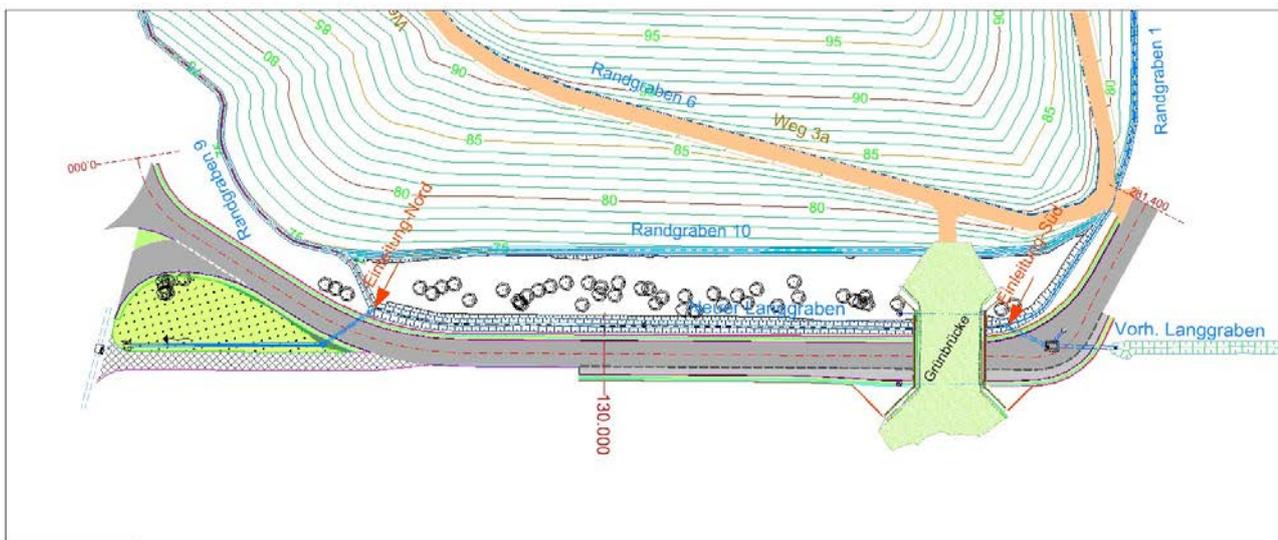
Lageplan Einleitung in den „Neuen“ Langgraben“
